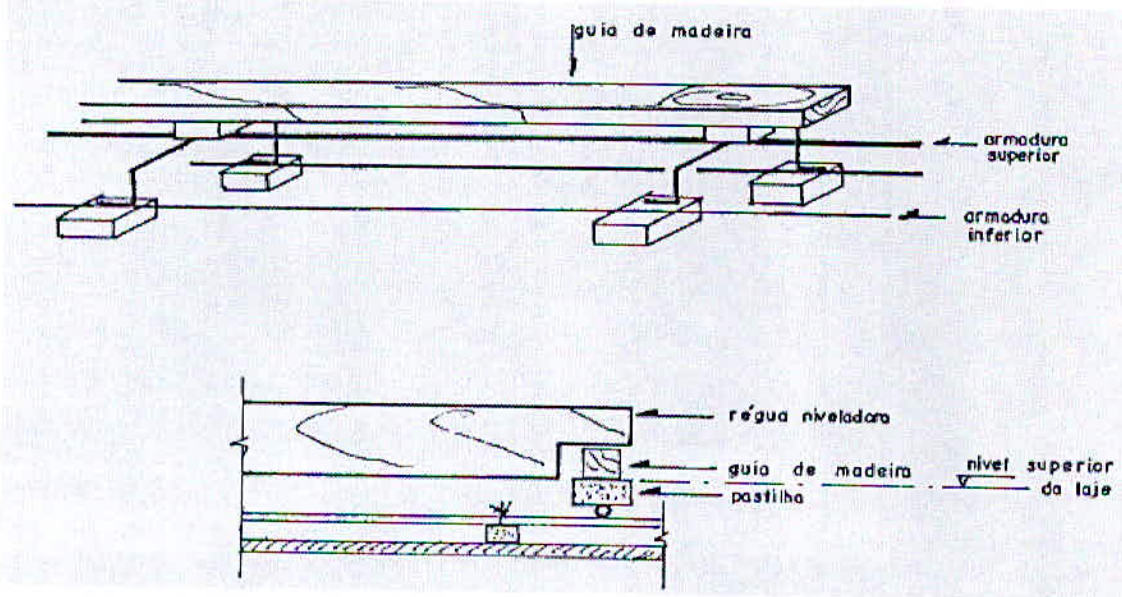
Detalhe da colocação de caranguejos no posicionamento das armaduras nas lajes.
